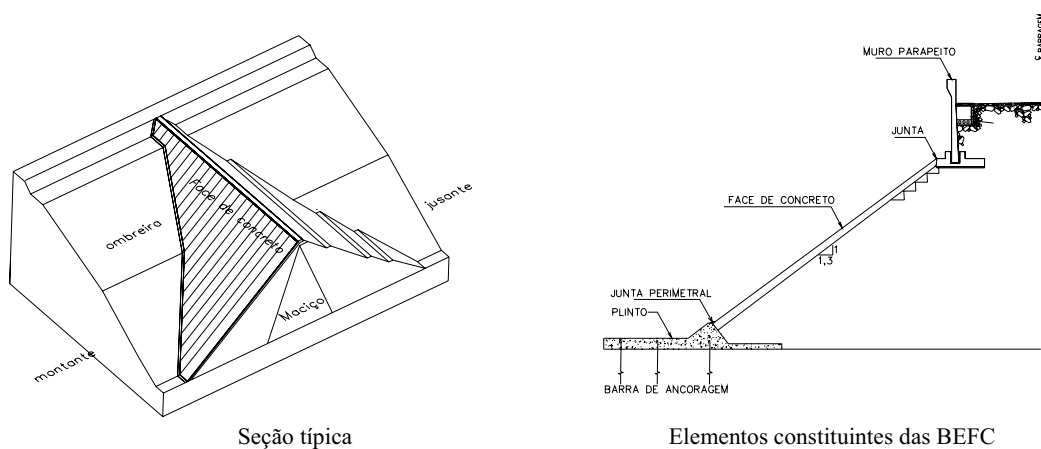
Barragem de Enrocamento com Face de Concreto.
